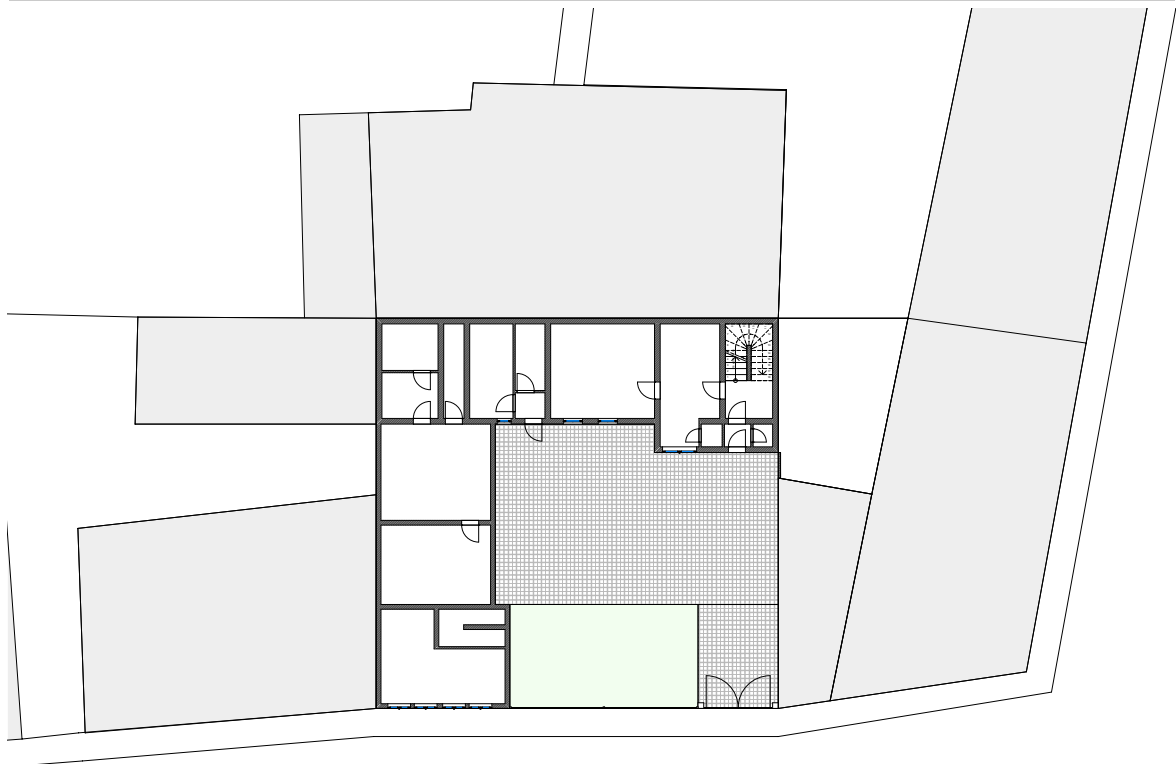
Lageplan: Fröhlichgasse im Bestand
